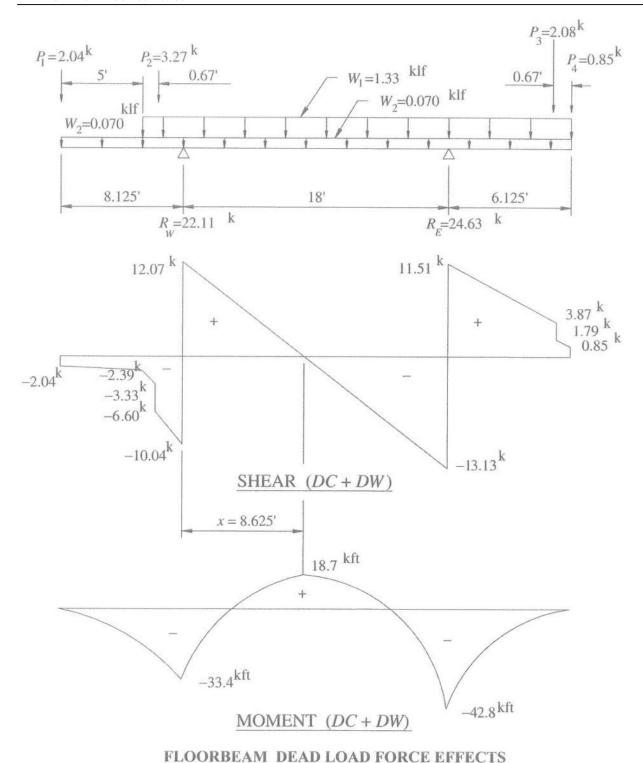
Efectos de la fuerza de carga muerta de la viga intermedia del piso
